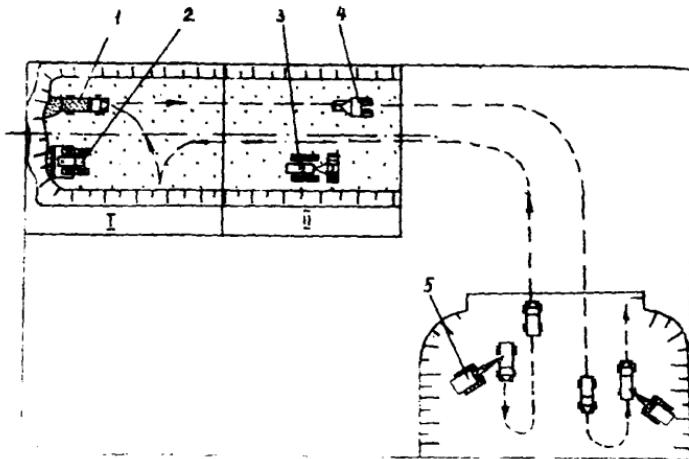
Рис. II. Технологическая схема сооружения грунтовой дороги без покрытия с разработкой грунта в карьерах:
